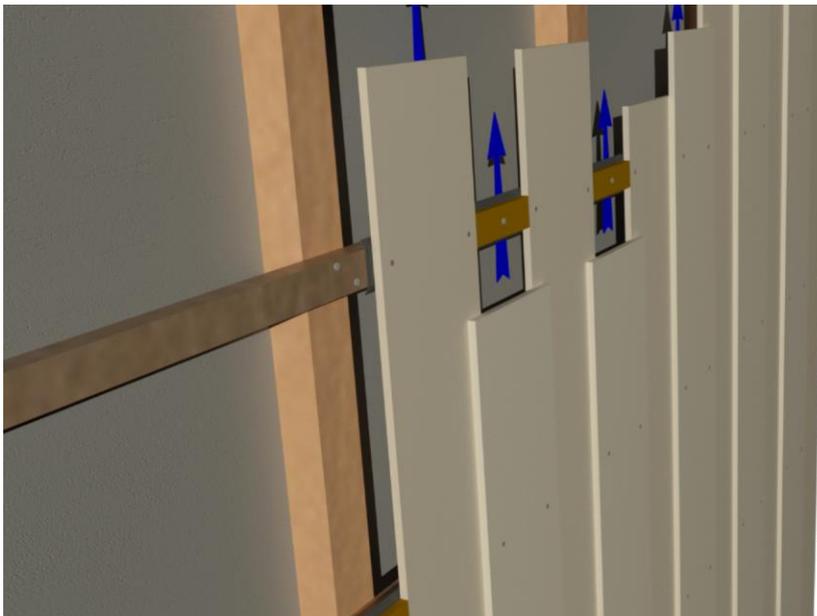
Pose verticale des lames CEDRAL LAP sans isolant
